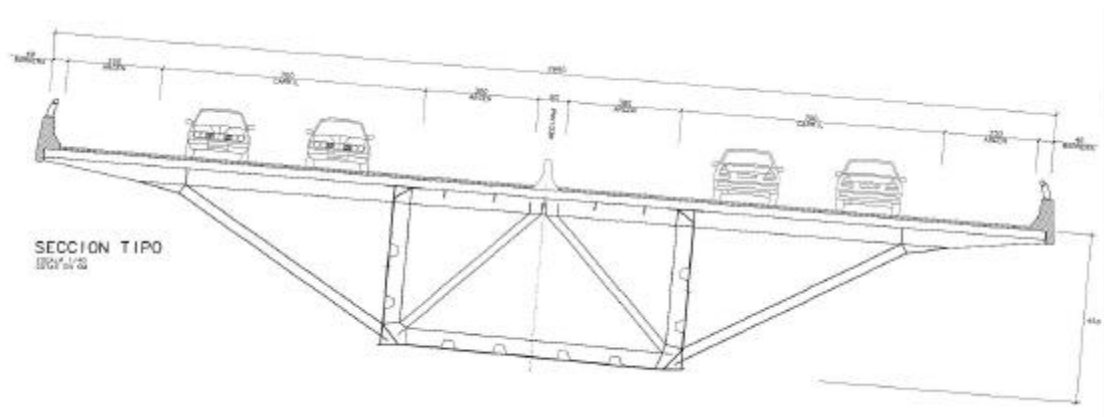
Sección transversal tipo. Viaducto de As Nogais
